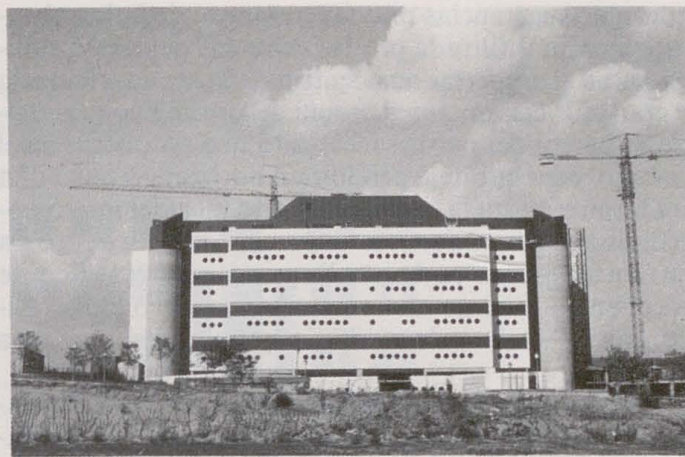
TERSSE & COLMENARES: Centro Nacional de Ingeniería Genética y Biotecnología. Fachada Sur.
